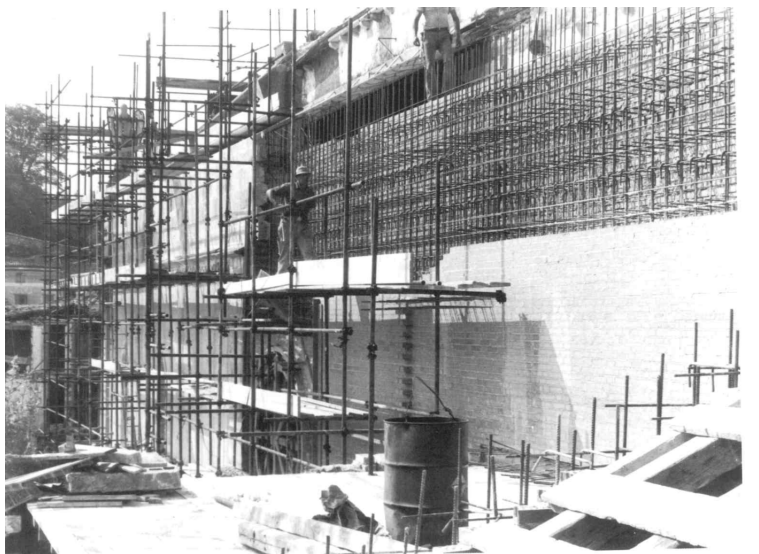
Lavori della navata destra, in particolare costruzione della muratura “a sandwich” di cemento armato con paramenti esterni in laterizio.
